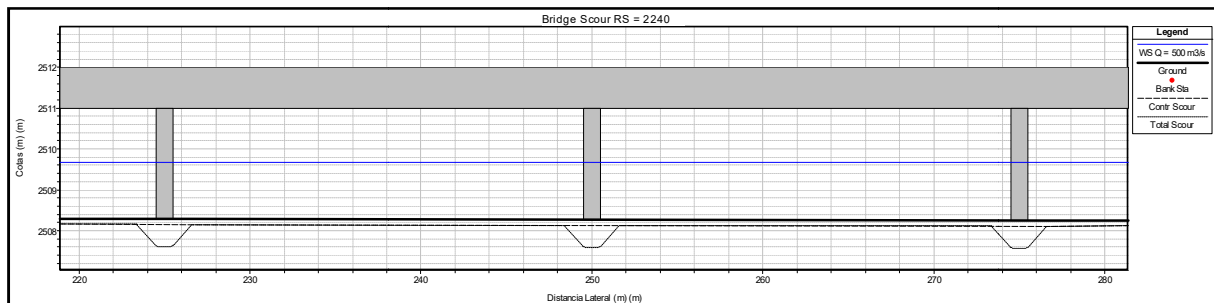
Detalle de las erosiones calculadas, por contracción + erosión local en pilas
